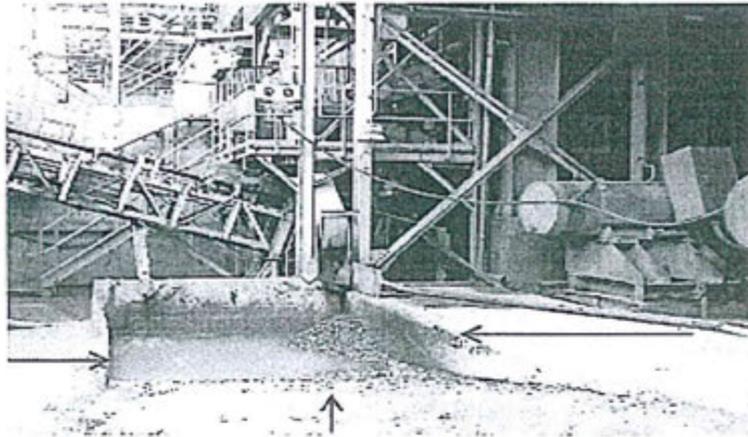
Losa de concreto y muro a la descarga del magneto #5.
